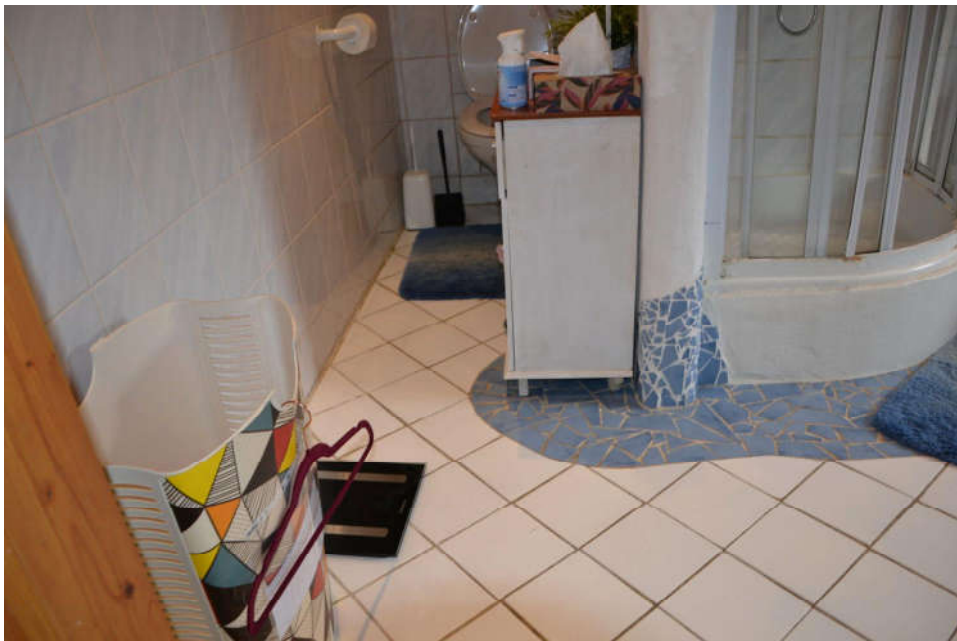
Dachgeschoss Bad, nicht fachhandwerkliche Ausführung, Fliesenverlegearbeiten
